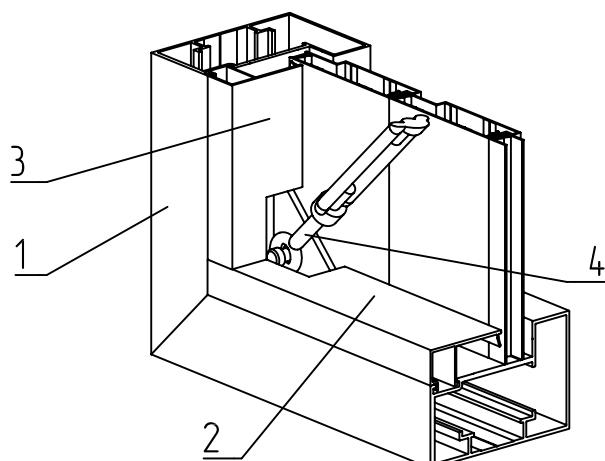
Установка штапика FLGU.400.0302, FLGU.400.0304 при наличии тросовой растяжки
